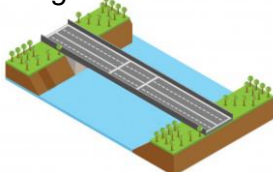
Planta General del Proyecto, Construcción del Puente Vehicular
